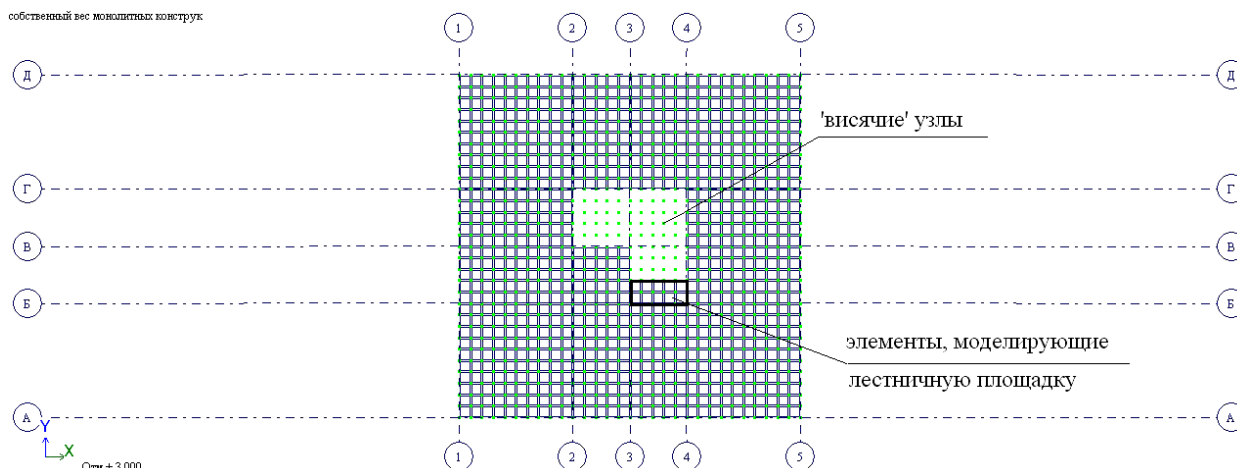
Отверстия в плите перекрытия 1-го этажа
